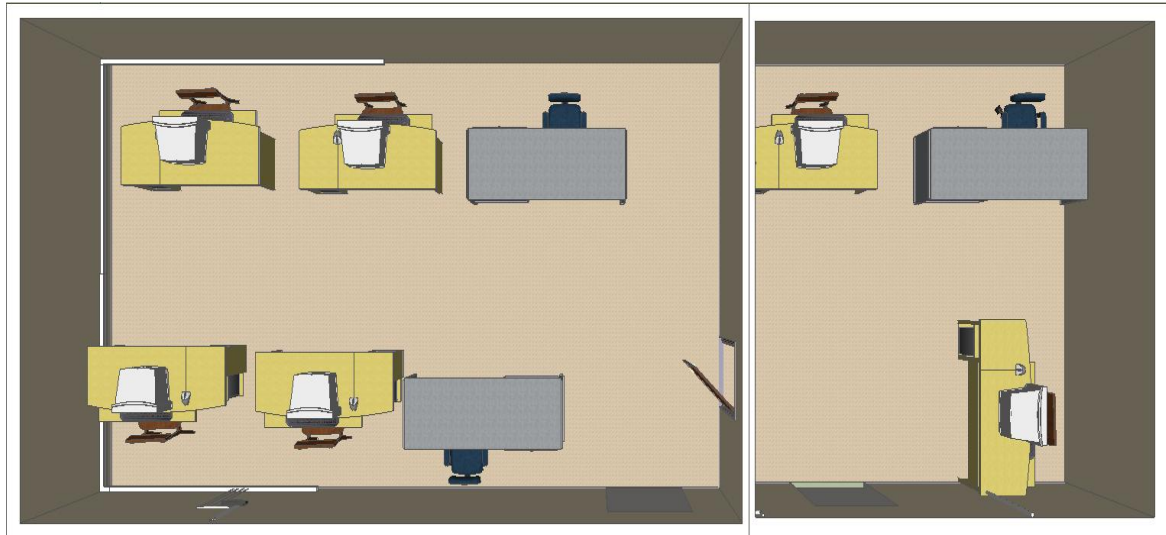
O, Vista de Planta de Sala de Maestros Bachillerato General (Anexo 6 Figura A-20)
